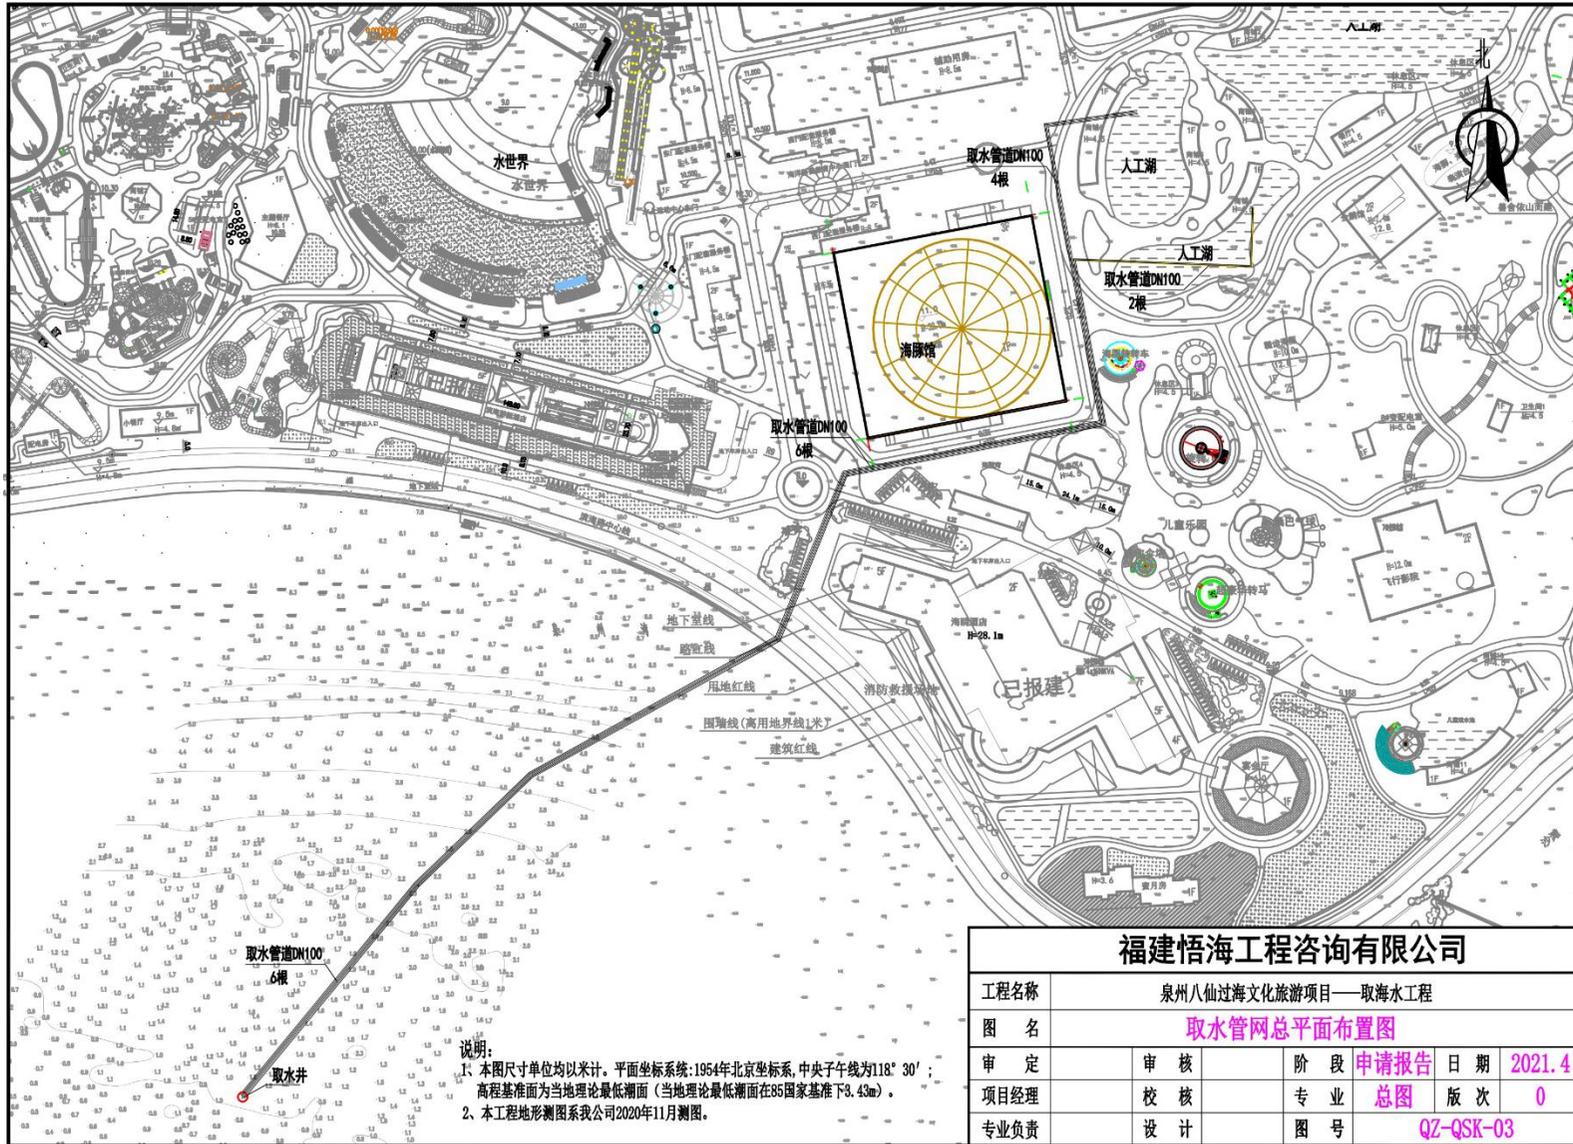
方案三（优化用海方案）工程总体平面布置图
